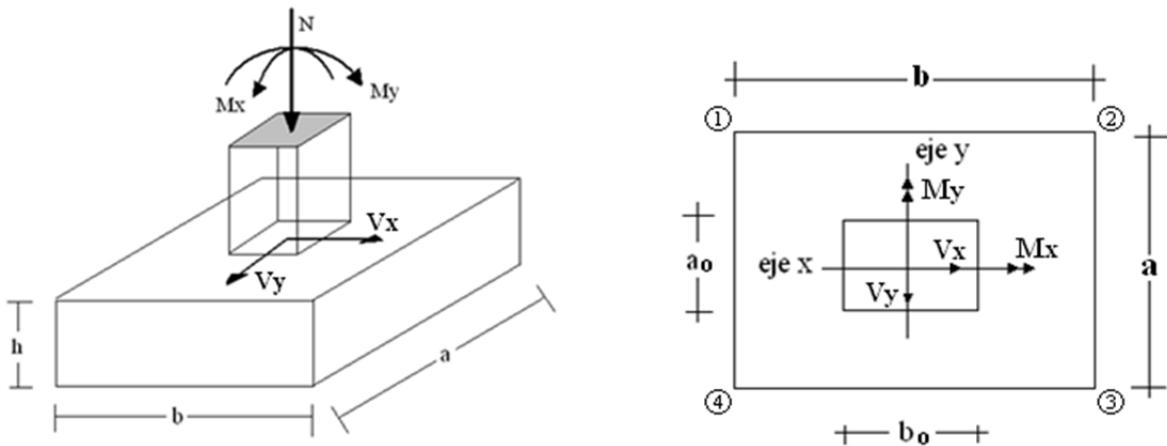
Esfuerzos actuantes en una zapata aislada
